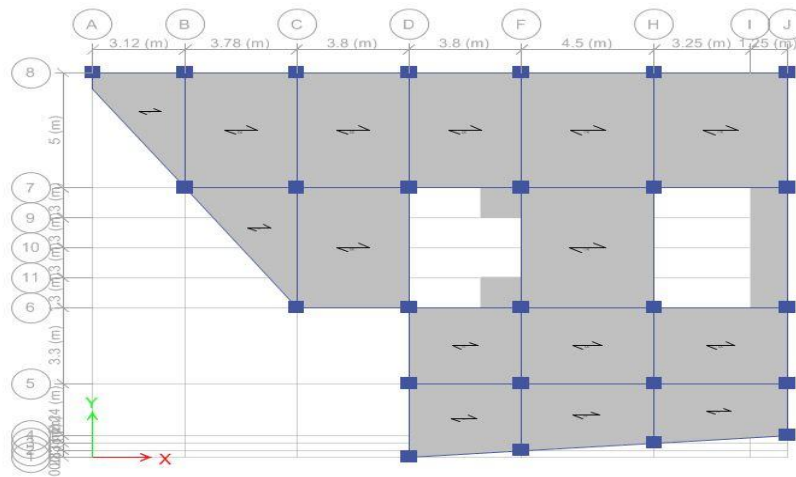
Disposition des poteaux de la structure porteuse auto-stable
